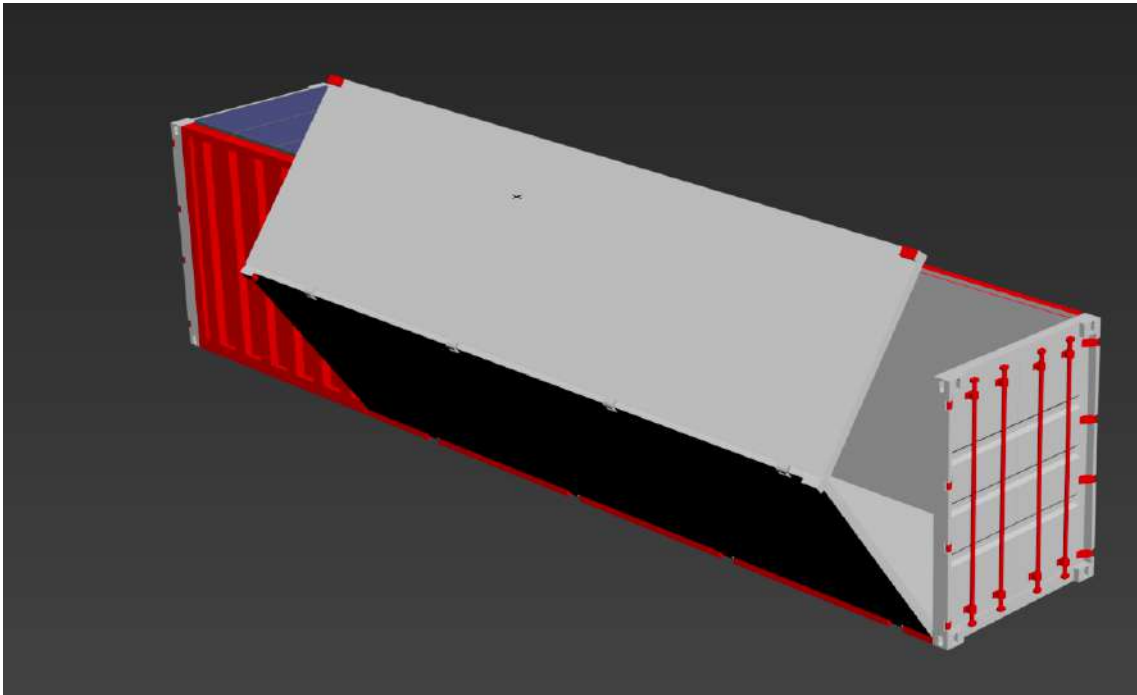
Render detalle apertura y cerrado container “Fuente: Elaboración propia”
